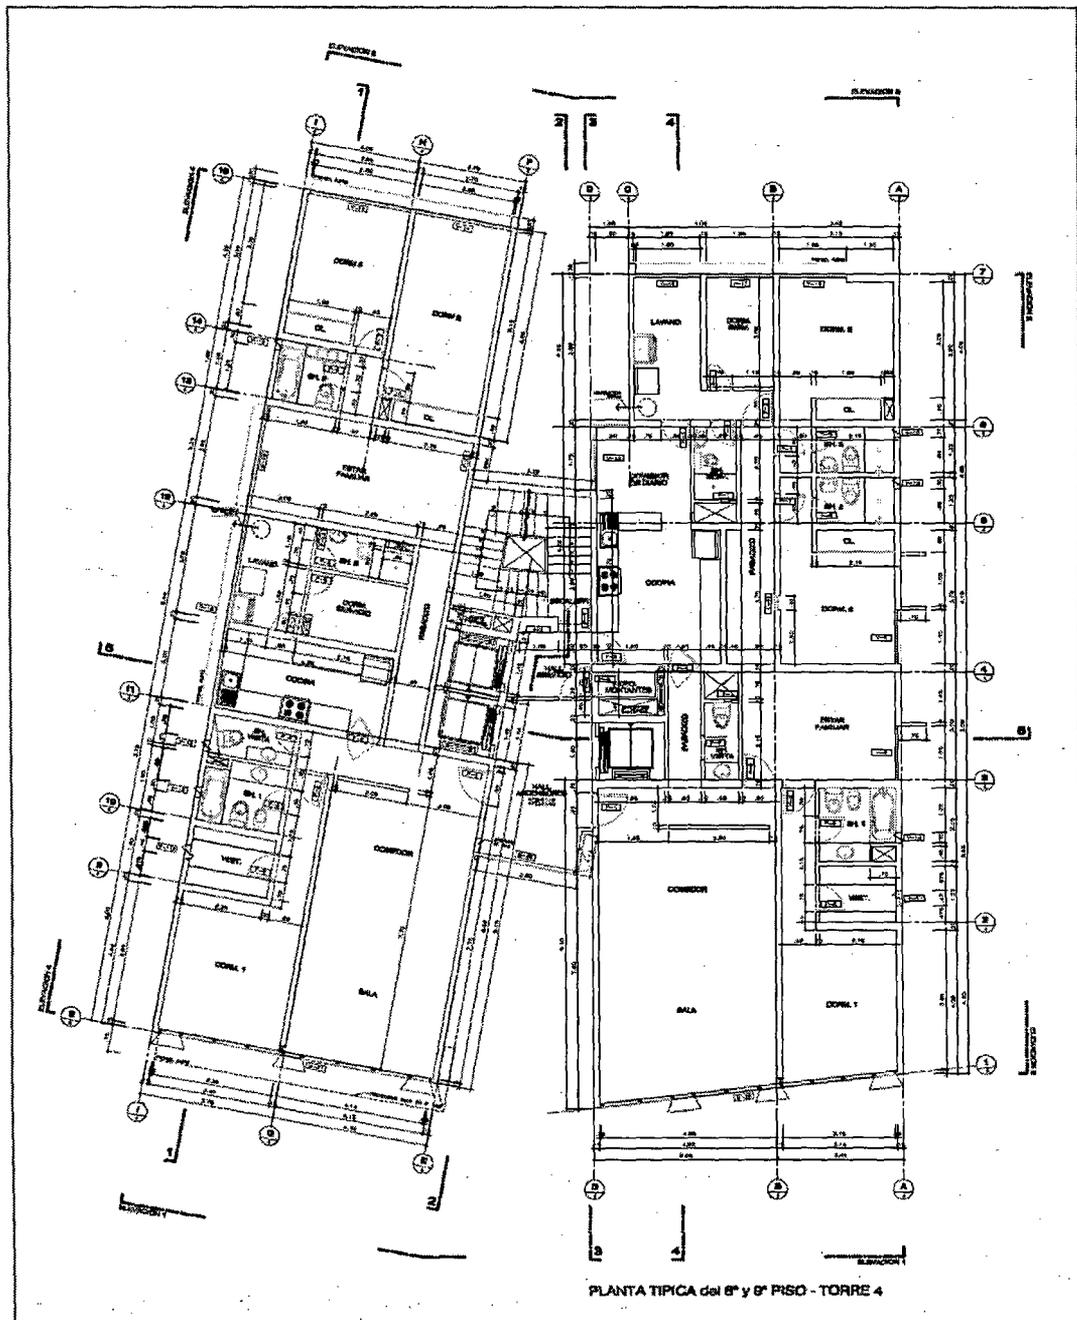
Planta Típica Torre 4 del proyecto Golf Millenium
